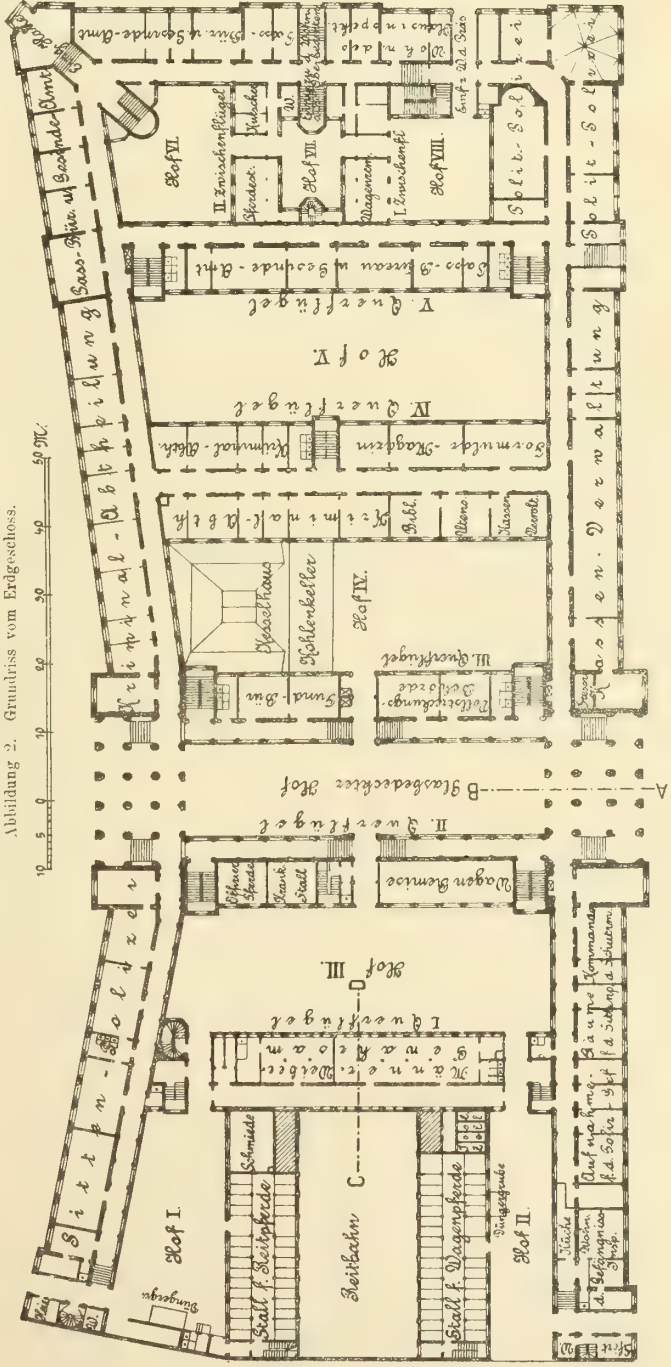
Grundriss vom Erdgeschoss.
